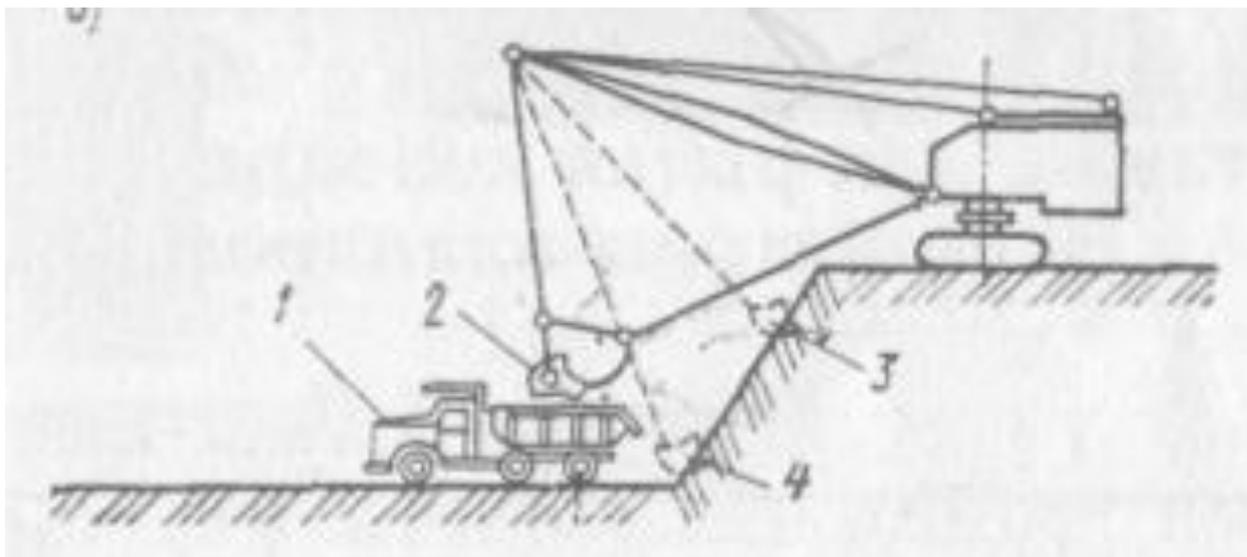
Схема разработки и погрузки грунта экскаватором драглайн:
